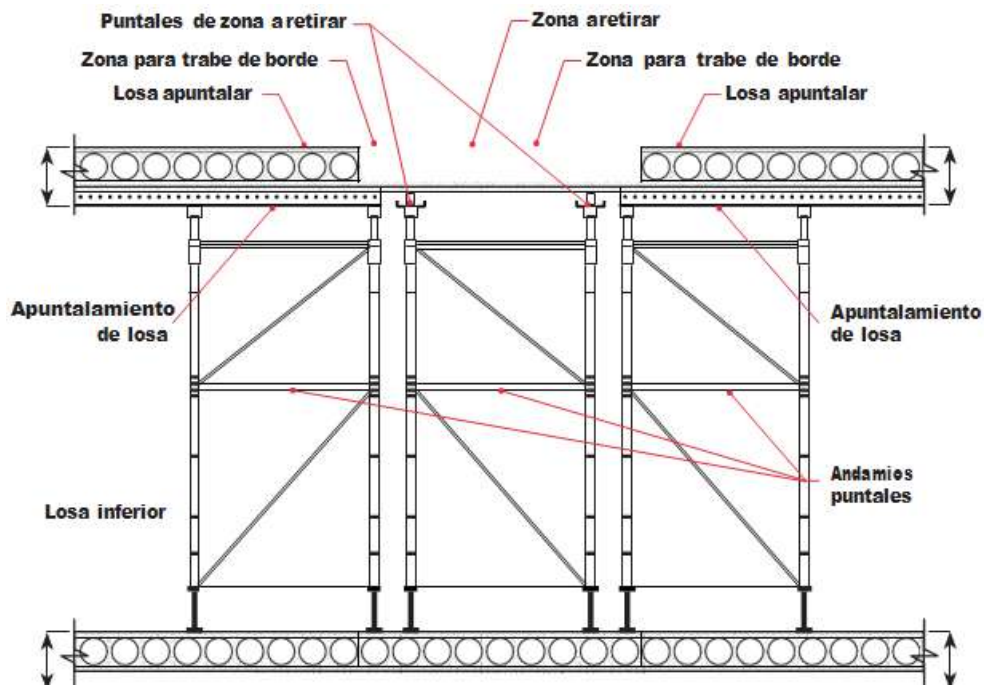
Detalle de corte de losa y colocación de viga de borde para cortes con máximas dimensiones
